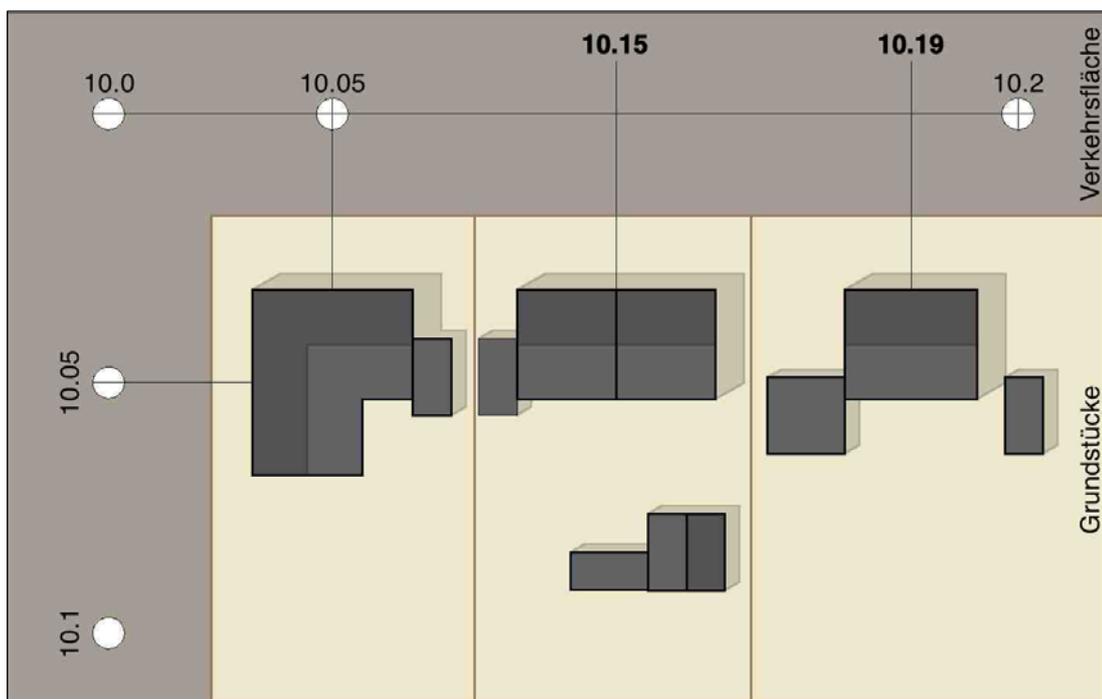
Schema zur Ermittlung der baulichen Höhe
